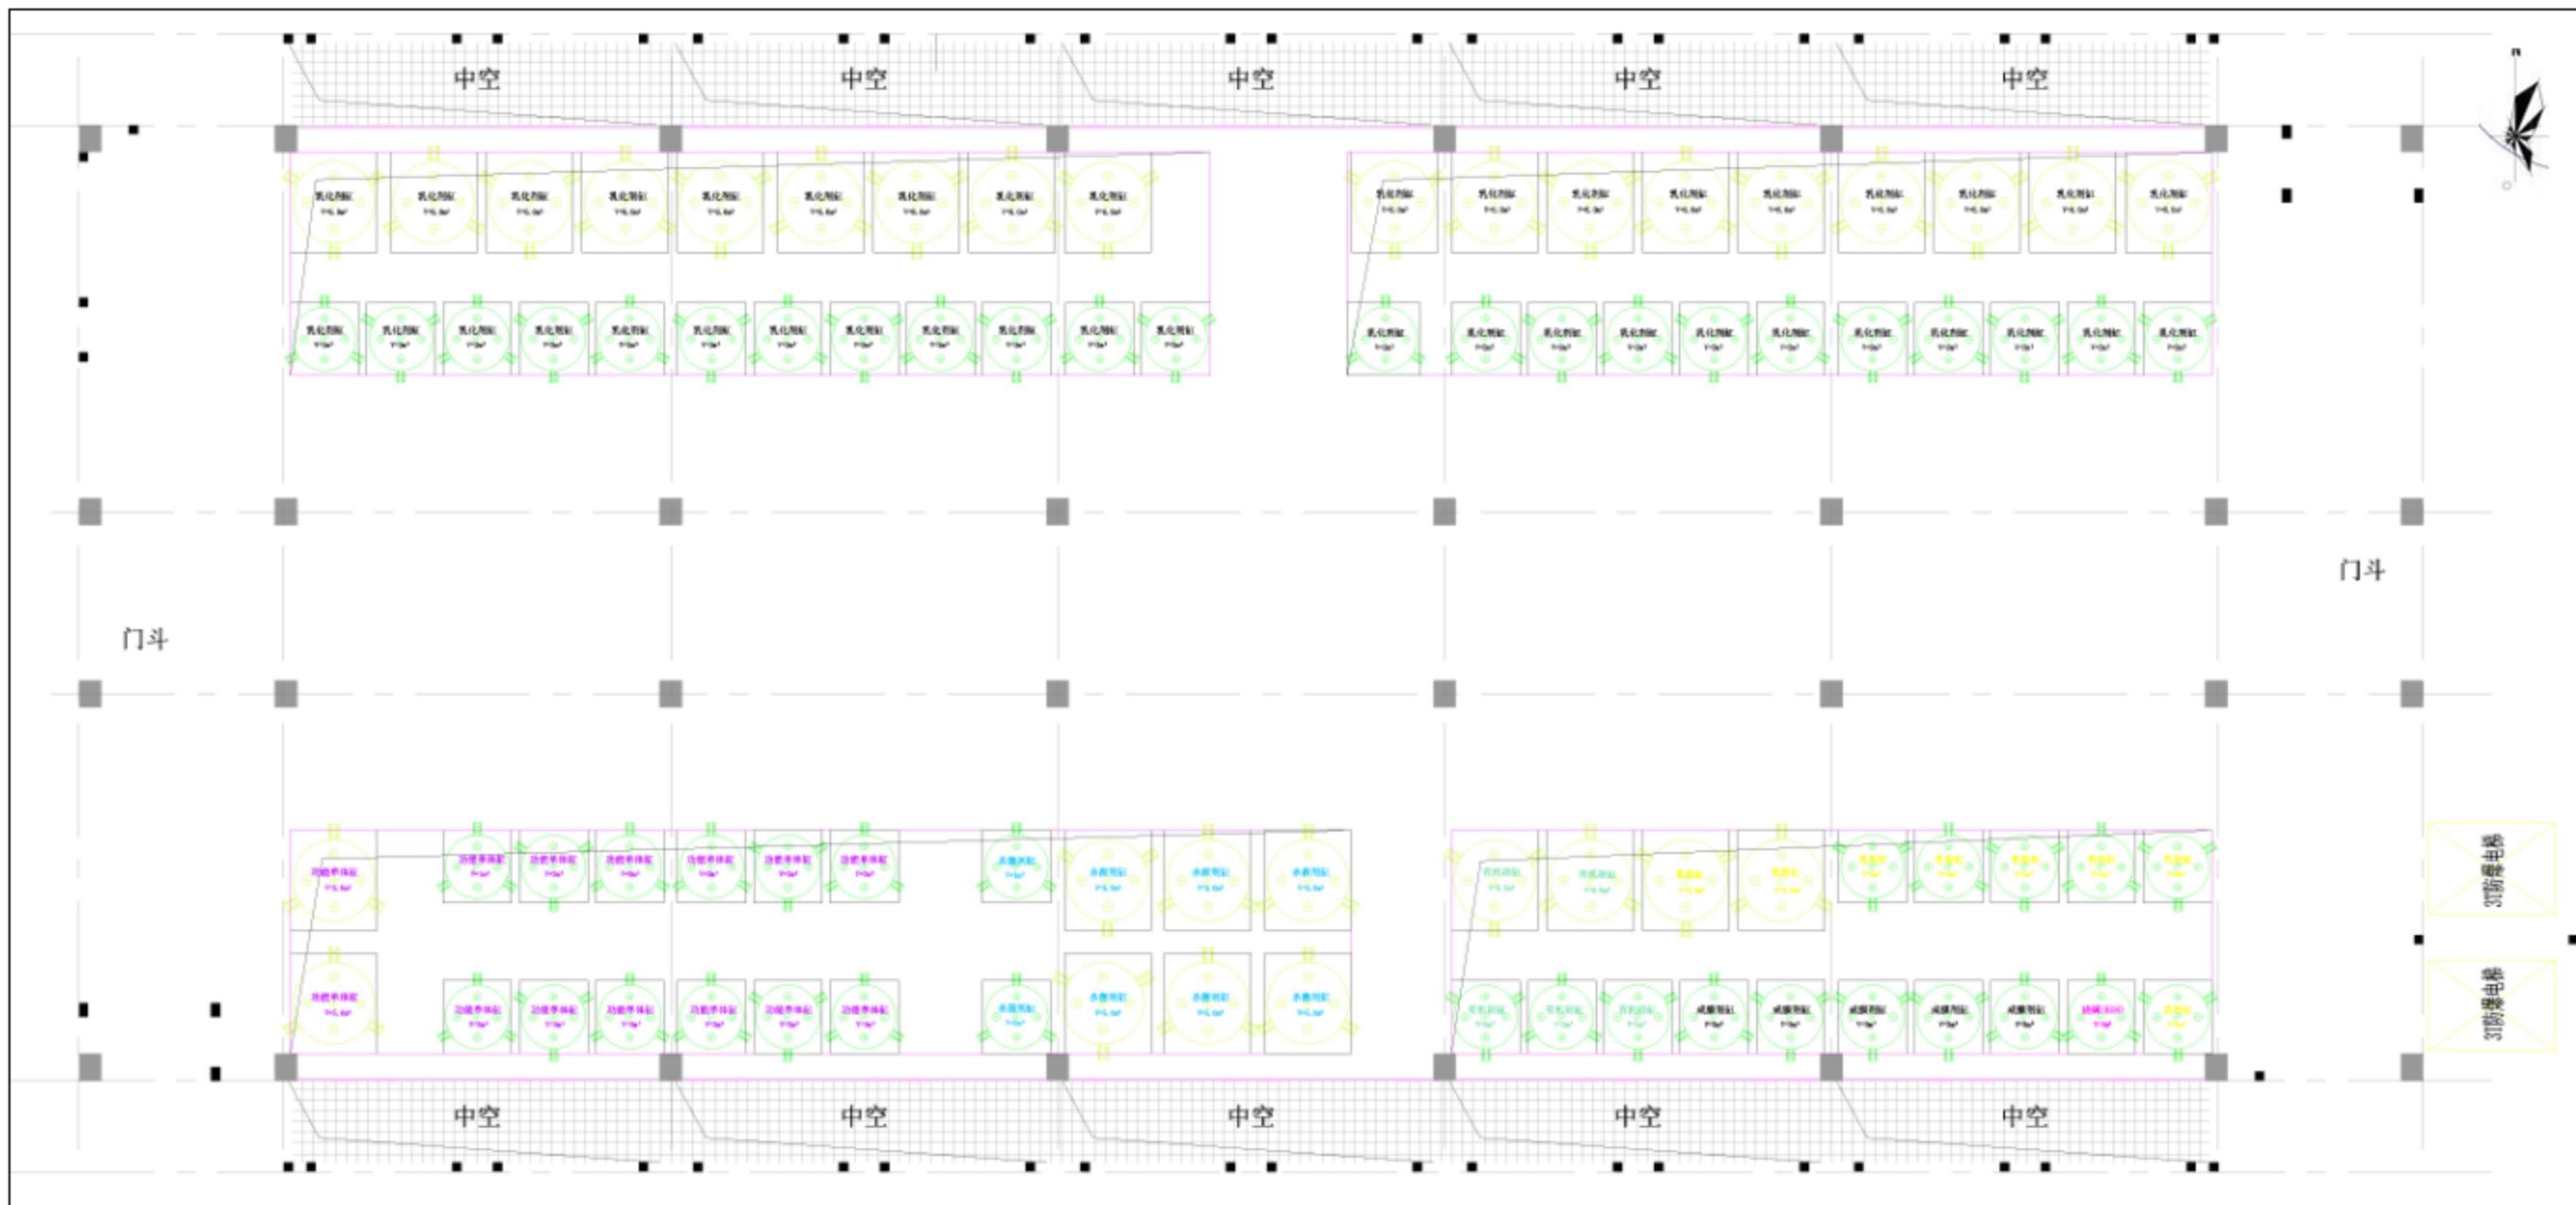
甲类车间A5层平面布置图（比例尺1:100）
